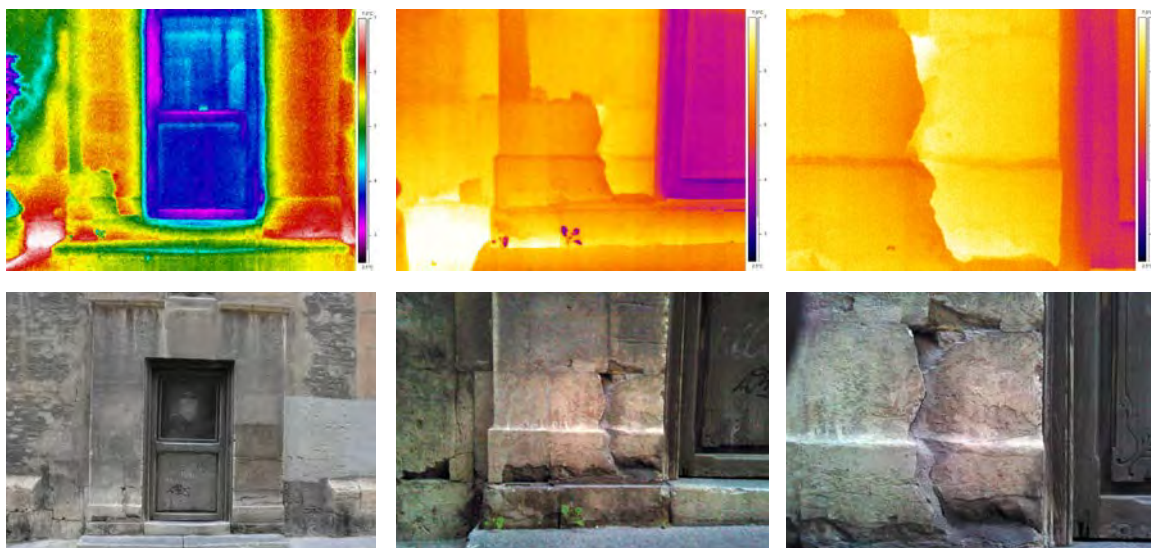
Vista general y detalle de un desconchado (fachada oeste).
